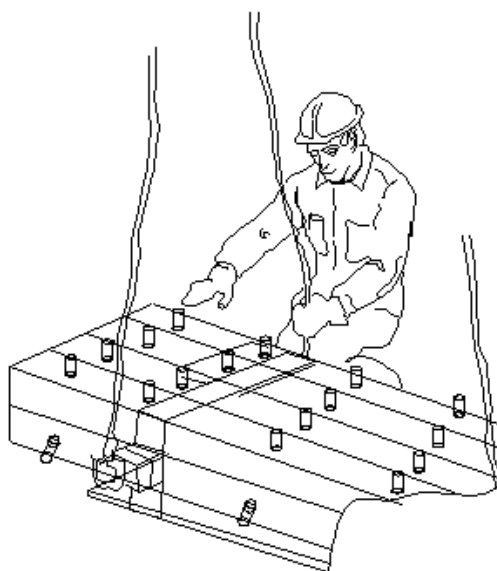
Строповка стропил перед подъемом на кровлю
